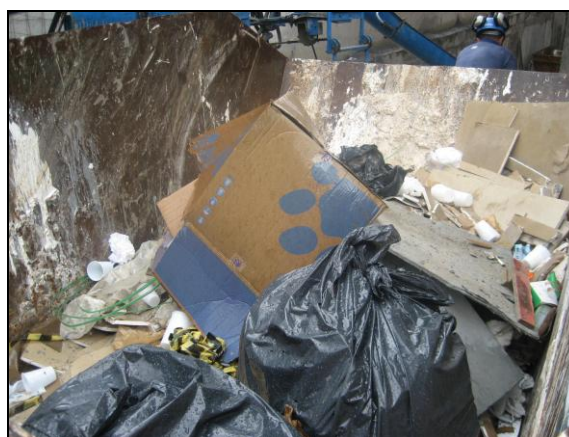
CAÇAMBA MISTURADA PARA POSTERIOR SEPARAÇÃO POR TERCEIRIZADA (CONSTRUTORA 16).
